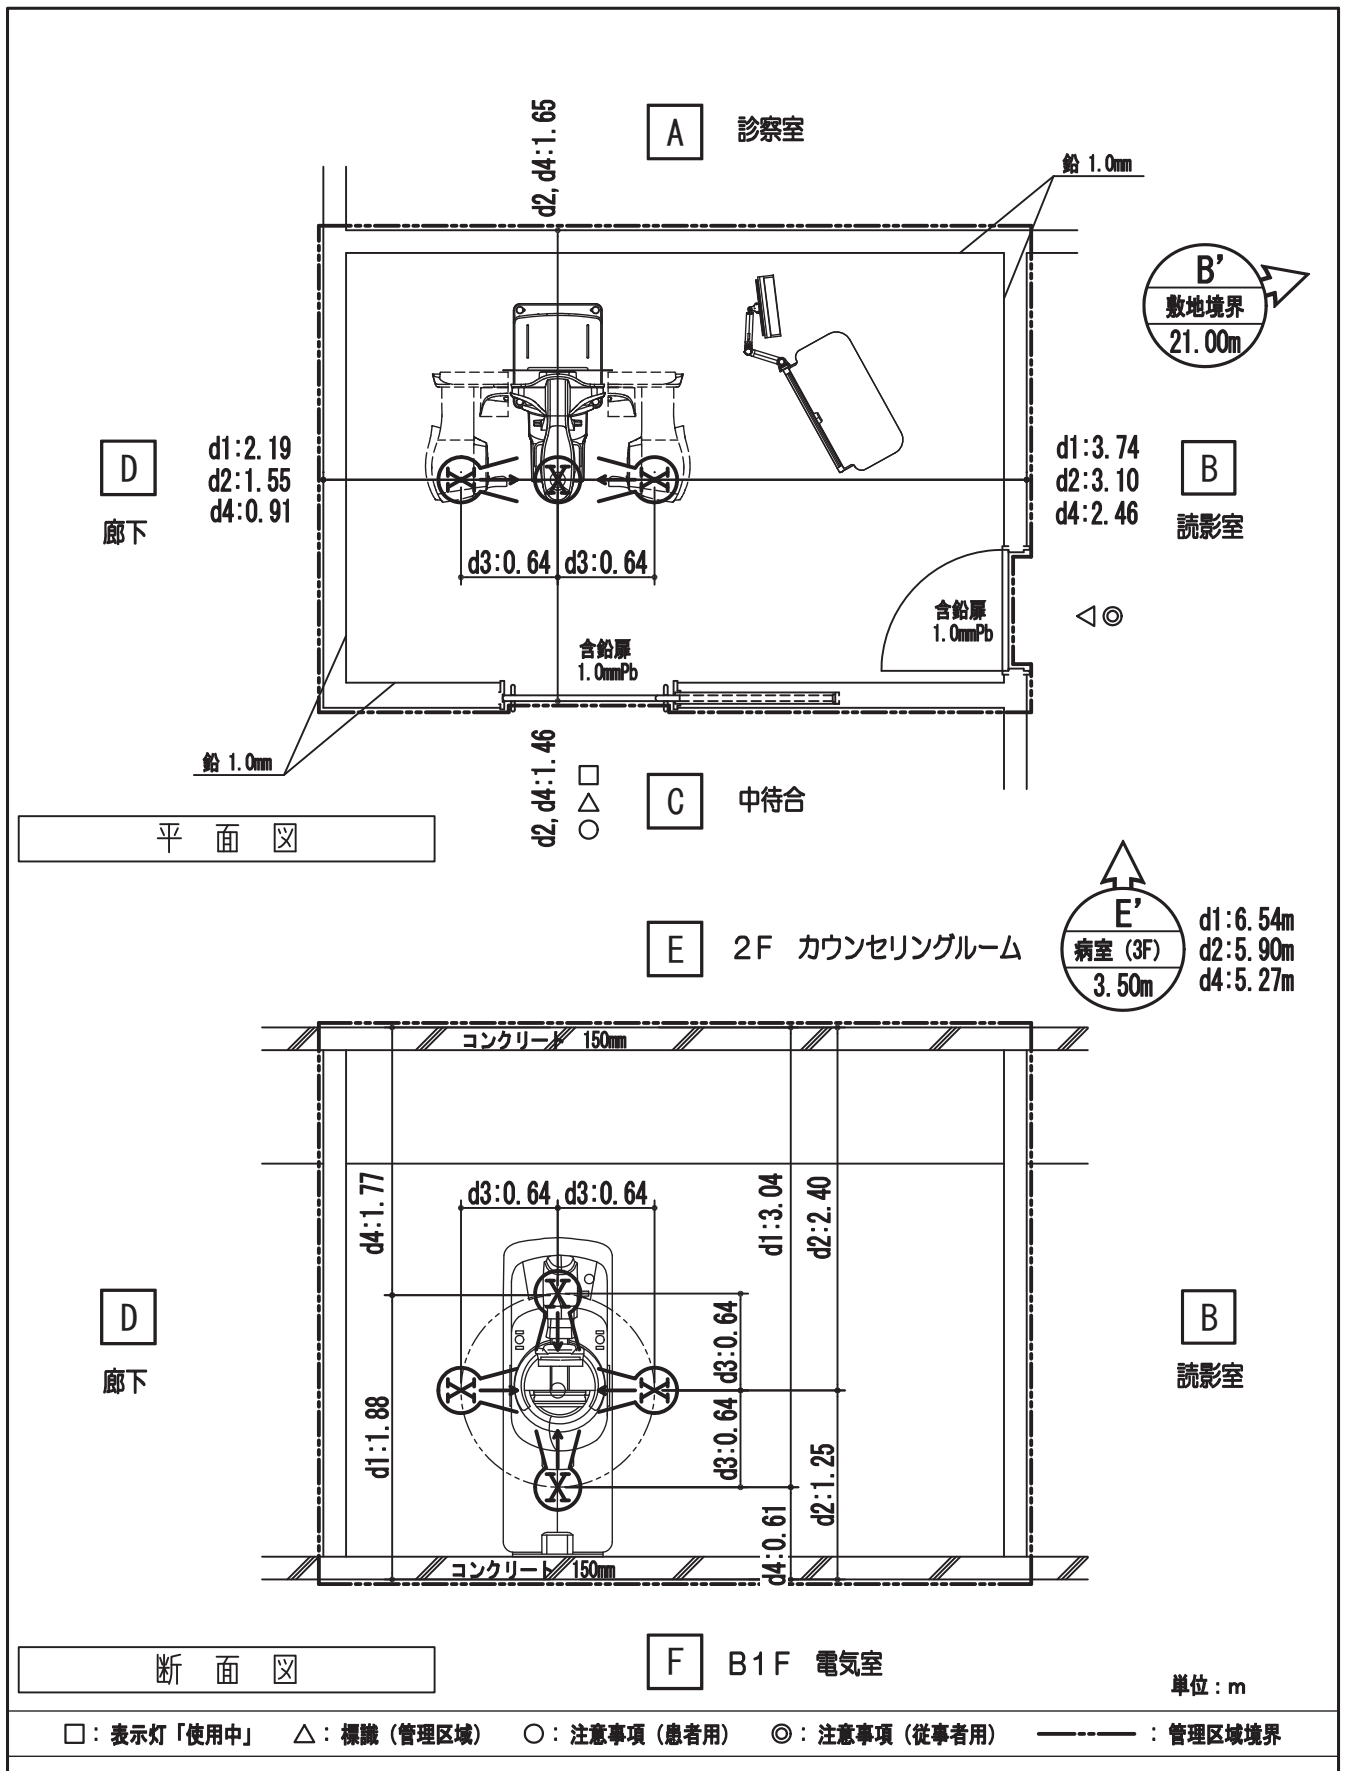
乳房用X線診断装置 乳房撮影 平面図・断面図
